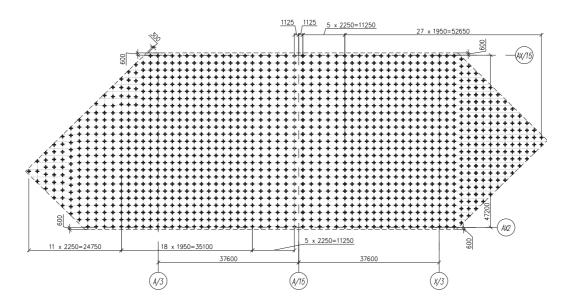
Размещение свай в свайном фундаменте зданий Амир и Хан при регулярном шаге свай
